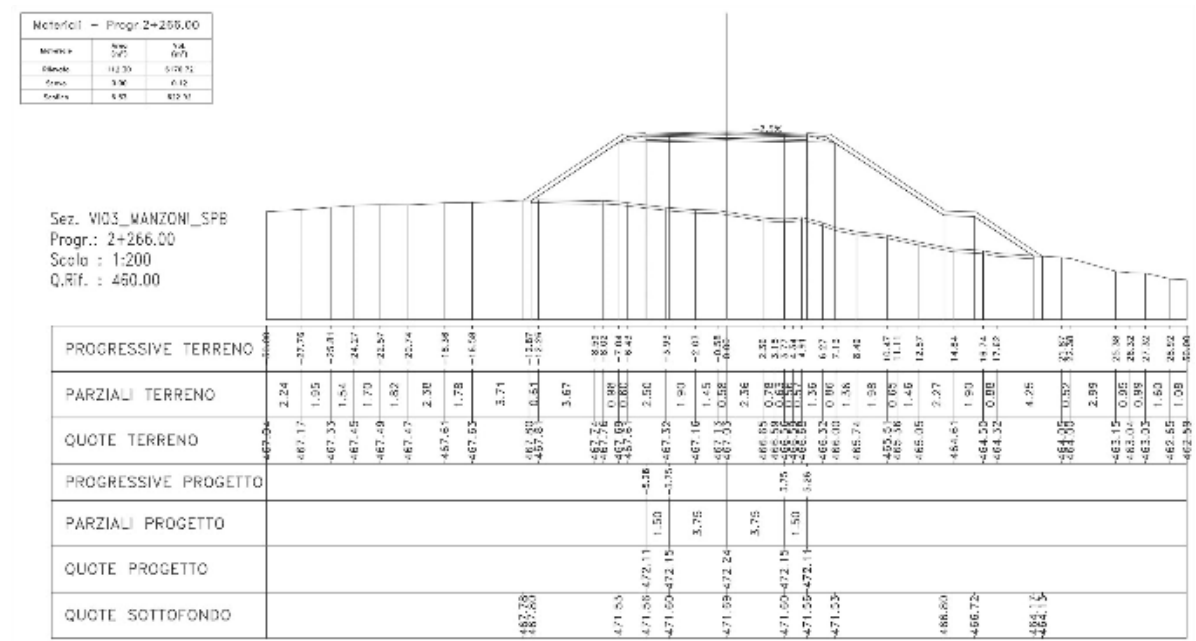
Sezione trasversale di progetto VI03_Viadotto Rio Manzoni
